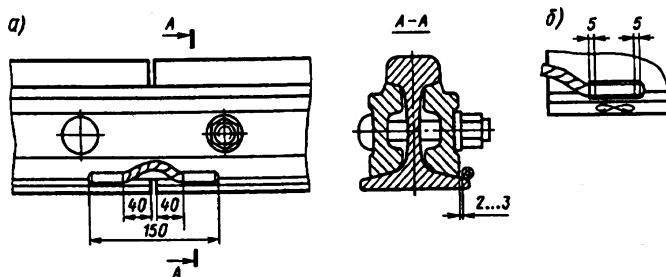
Схема установки (а) и приварки (б) соединителя к подошве
